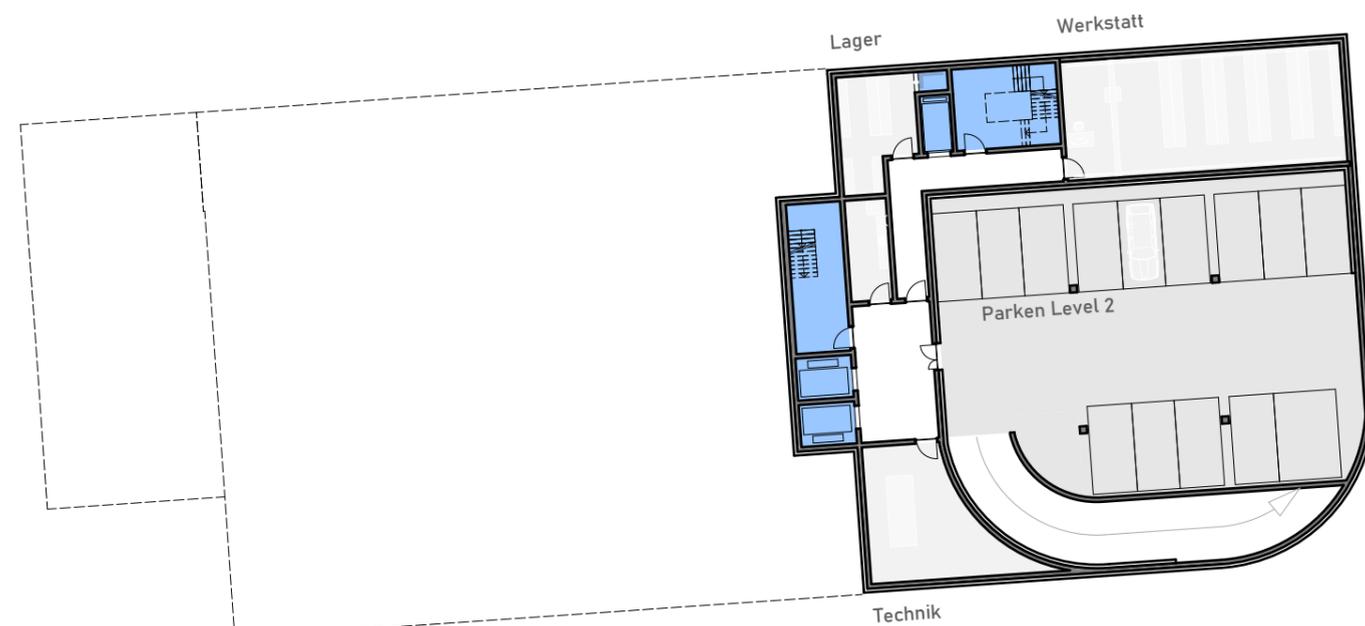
Grundriss 2.UG Raumorganisation M1:400
